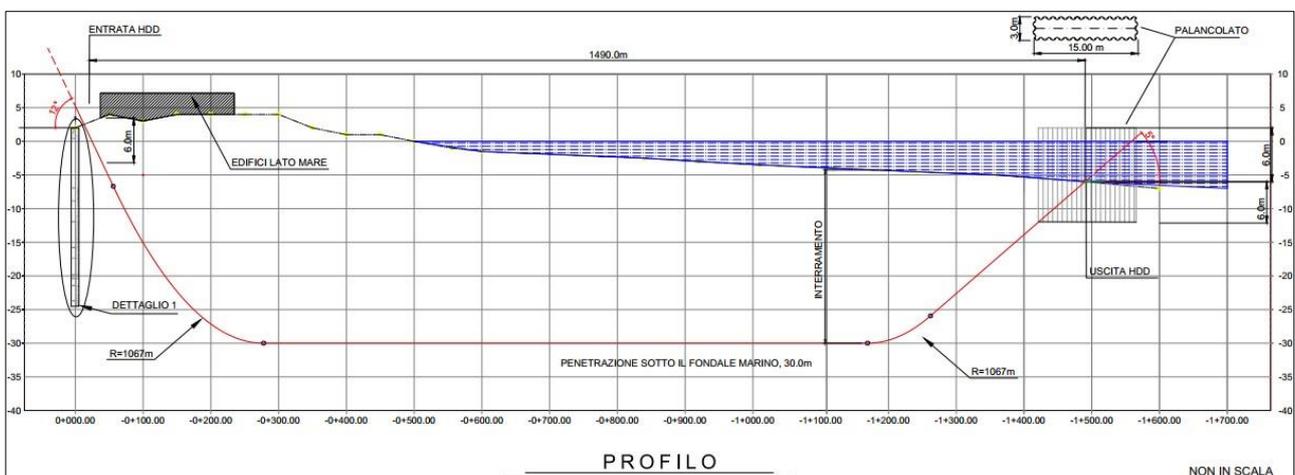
Planimetria e sezione della transizione Mare-Terra del cavo marino AAT 380 kV
